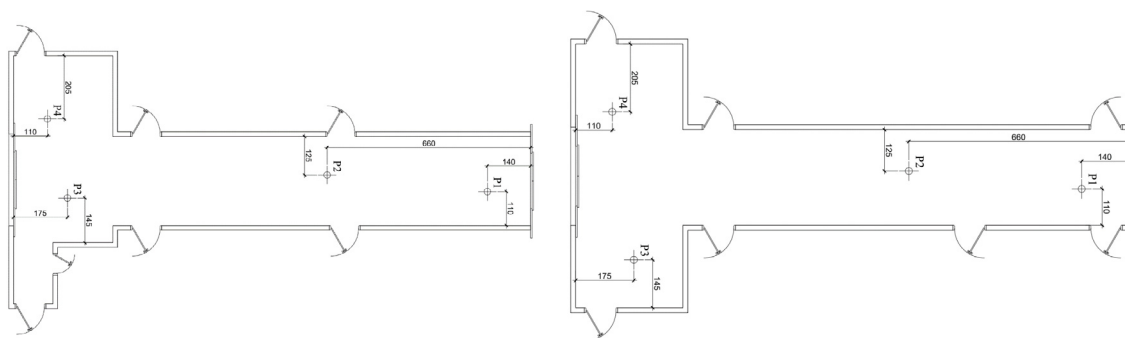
Locação de pontos (LAeq) no corredor do pavimento térreo (esq.) e pavimento superior (dir.)
